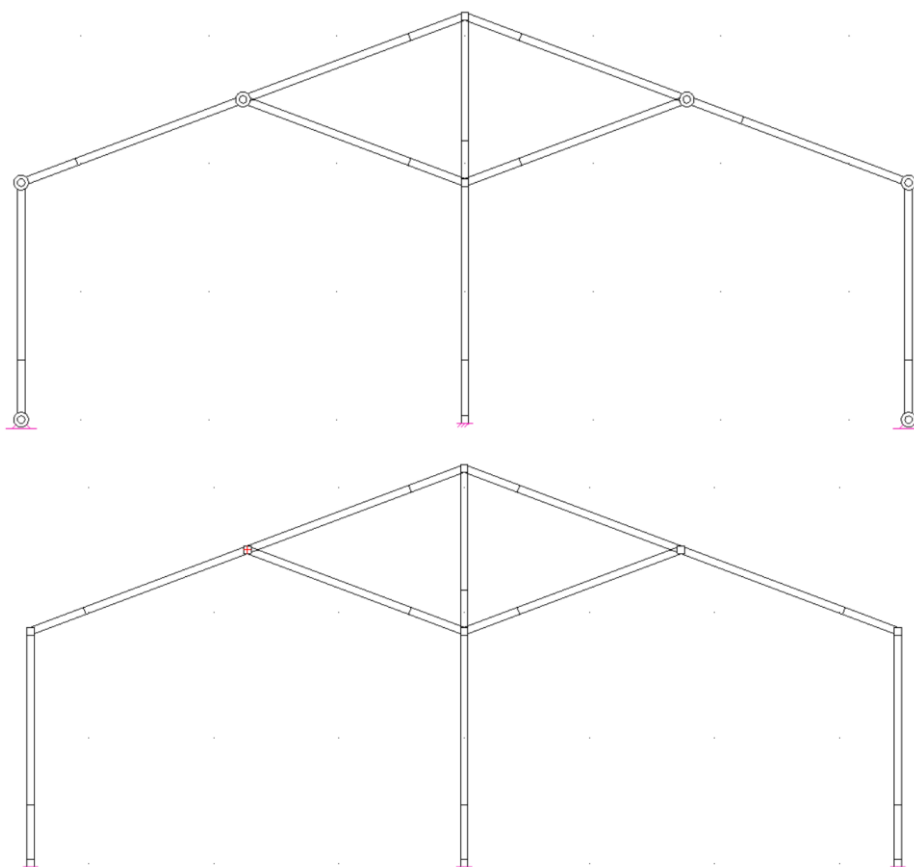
Arriba pórtico modelo 90 con uniones articuladas, abajo con uniones empotradas
